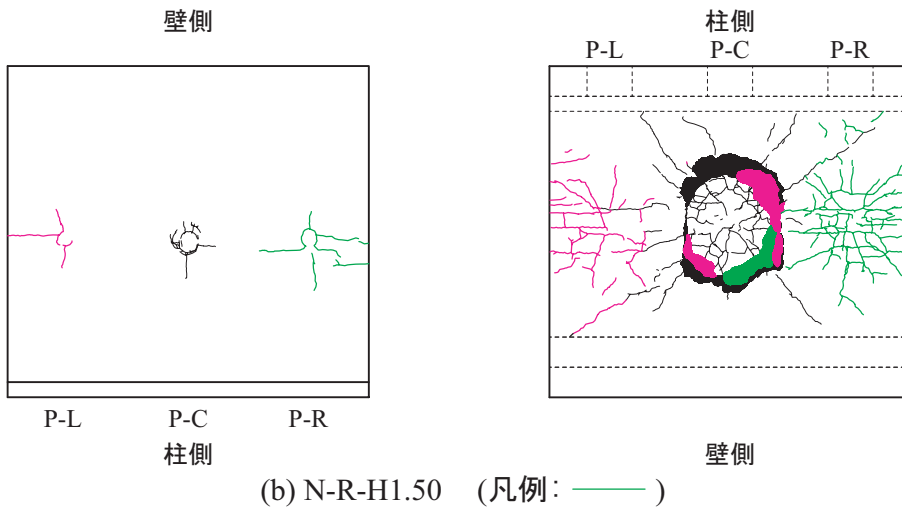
荷重位置 L および R に対する頂版上下面のひび割れ状況
